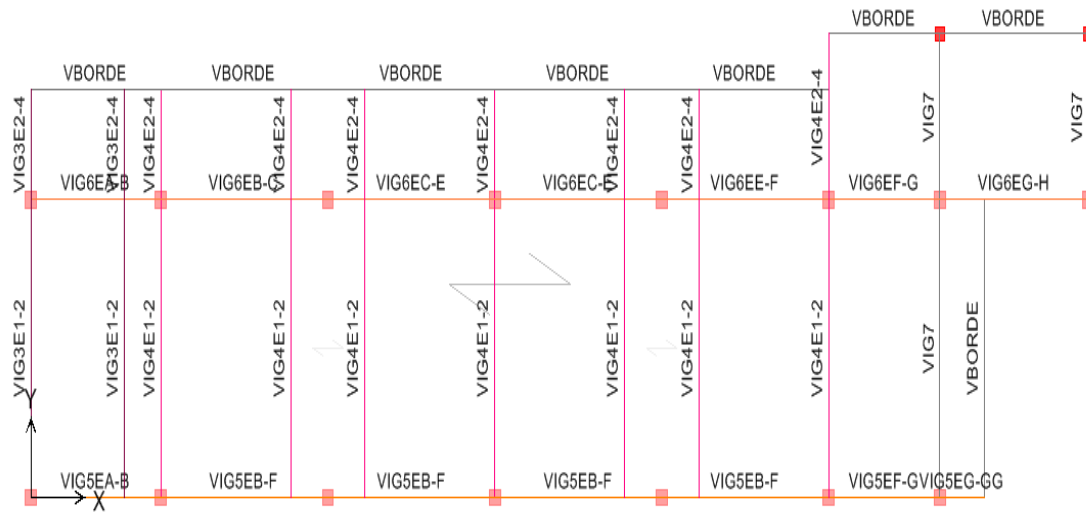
Elementos Tipo Viga – Planta Nivel N+2.8
